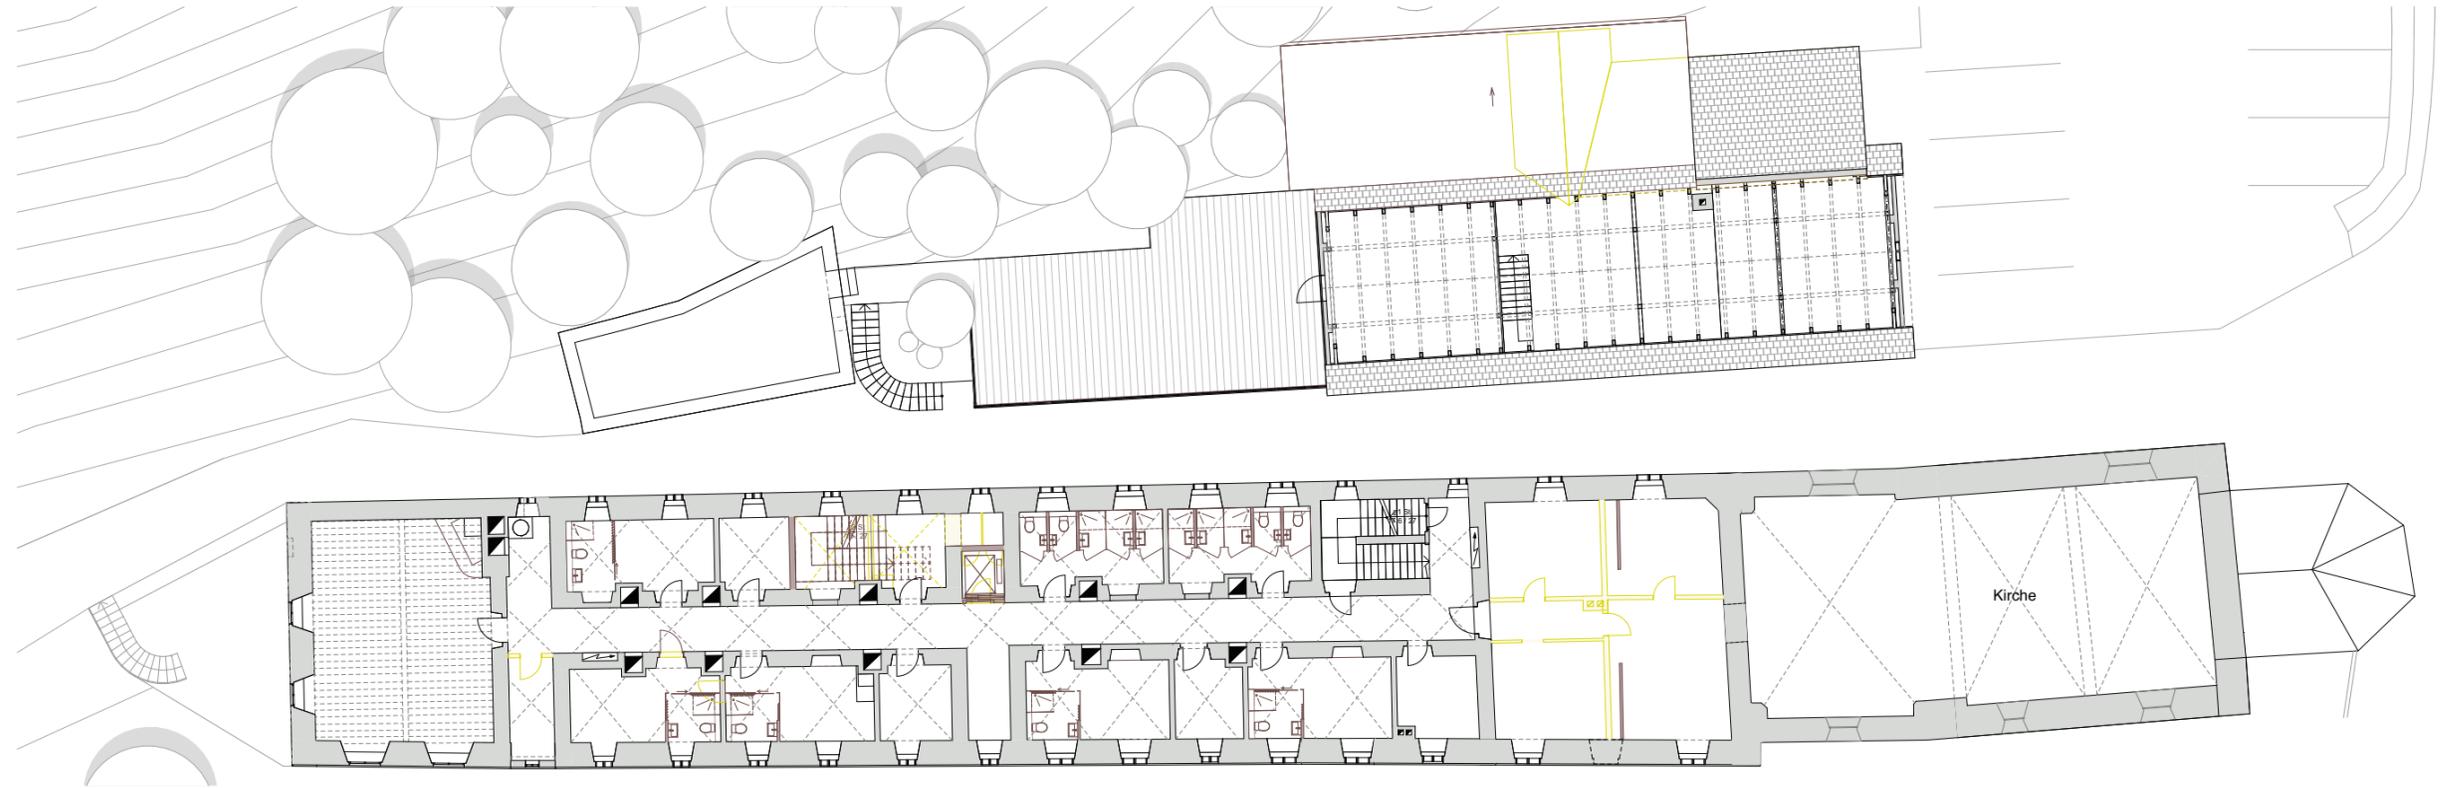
Bauliche Eingriffe. Obergeschoss Spitalstrak und Spitalkirche, Dachboden Wirtschaftstrak
